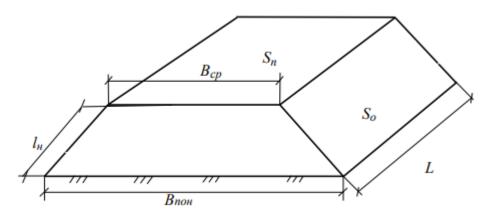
Схема к определению объемов планировочных работ
